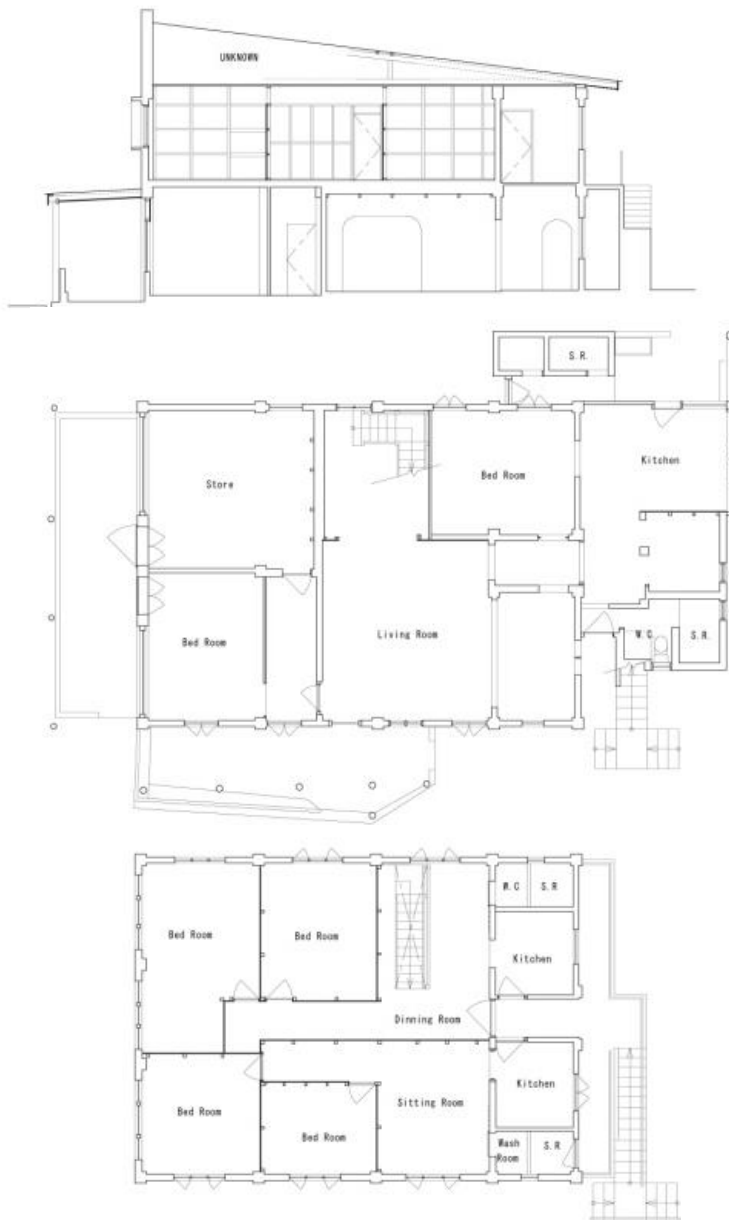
町家建築 Cタイプ 平面図、断面図
